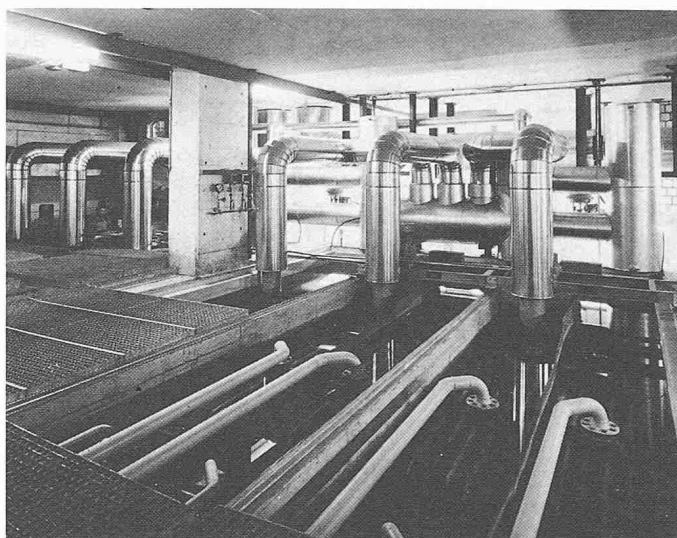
Seewasserbecken mit Plattenverdampfern, im Hintergrund der Seewassereinlauf
